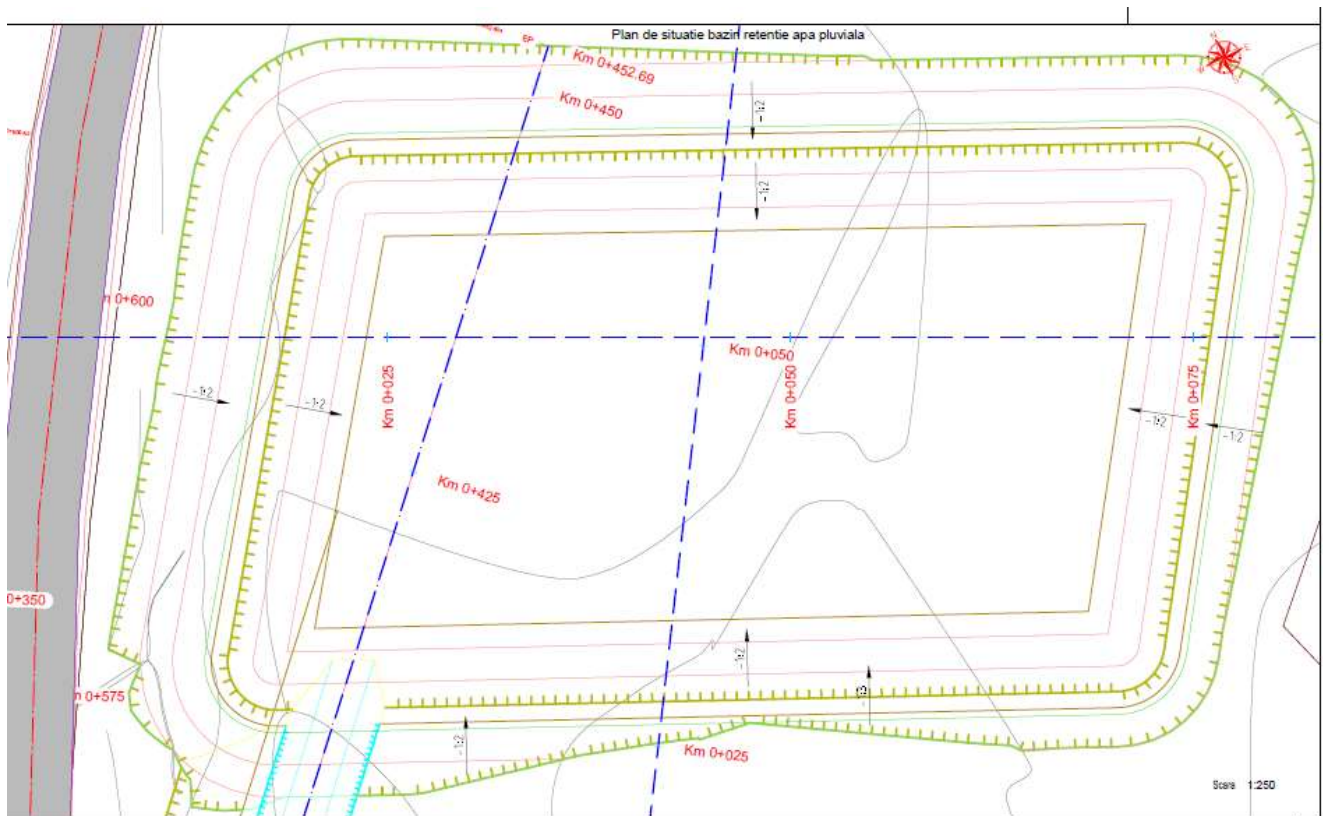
Bazin de retenție ape pluviale - Halda 4
